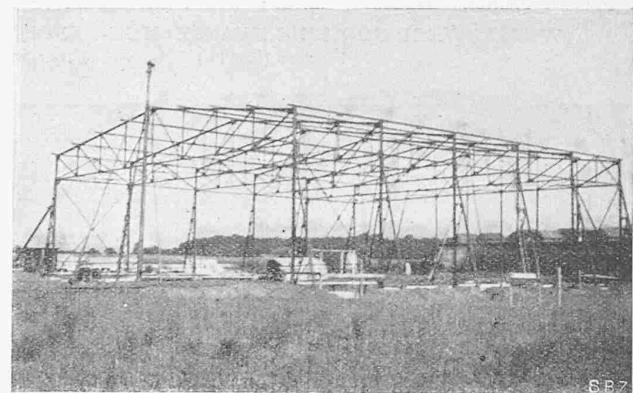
Fertig montierte Eisenkonstruktion der Halle.
